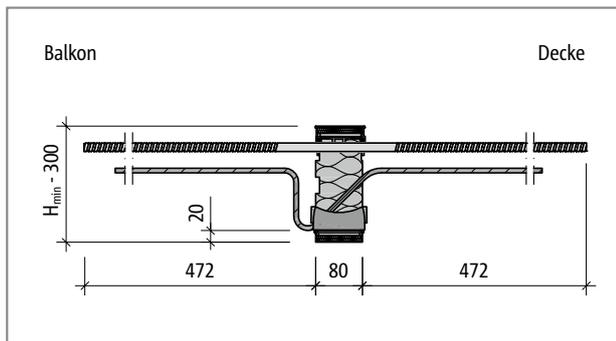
Schöck Isokorb® CT Typ KL-M6 bei REI120: Produktschnitt
